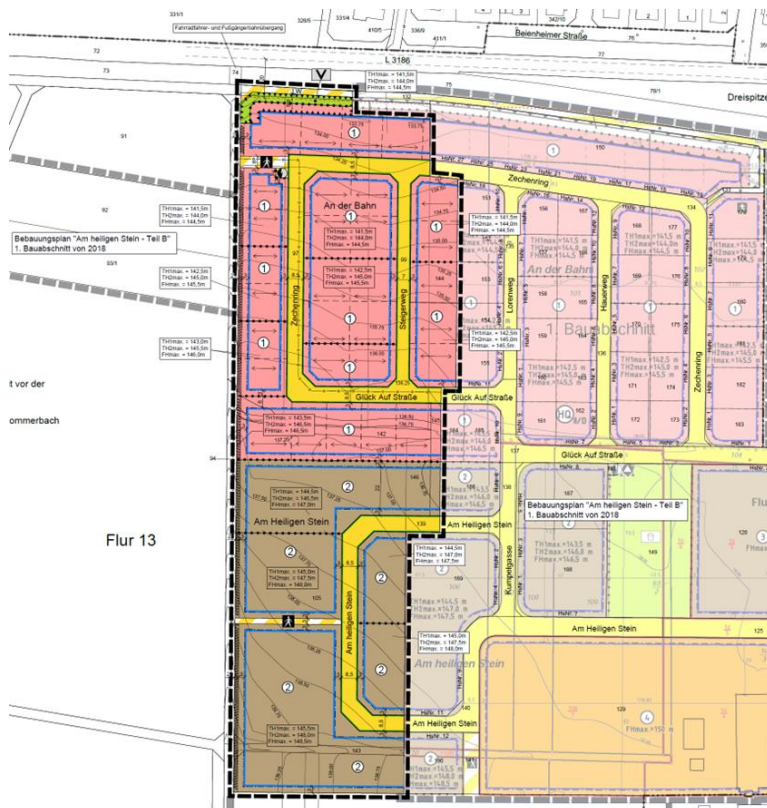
Bauabschnitt BA3 des B-Plans „Am Heiligen Stein“
